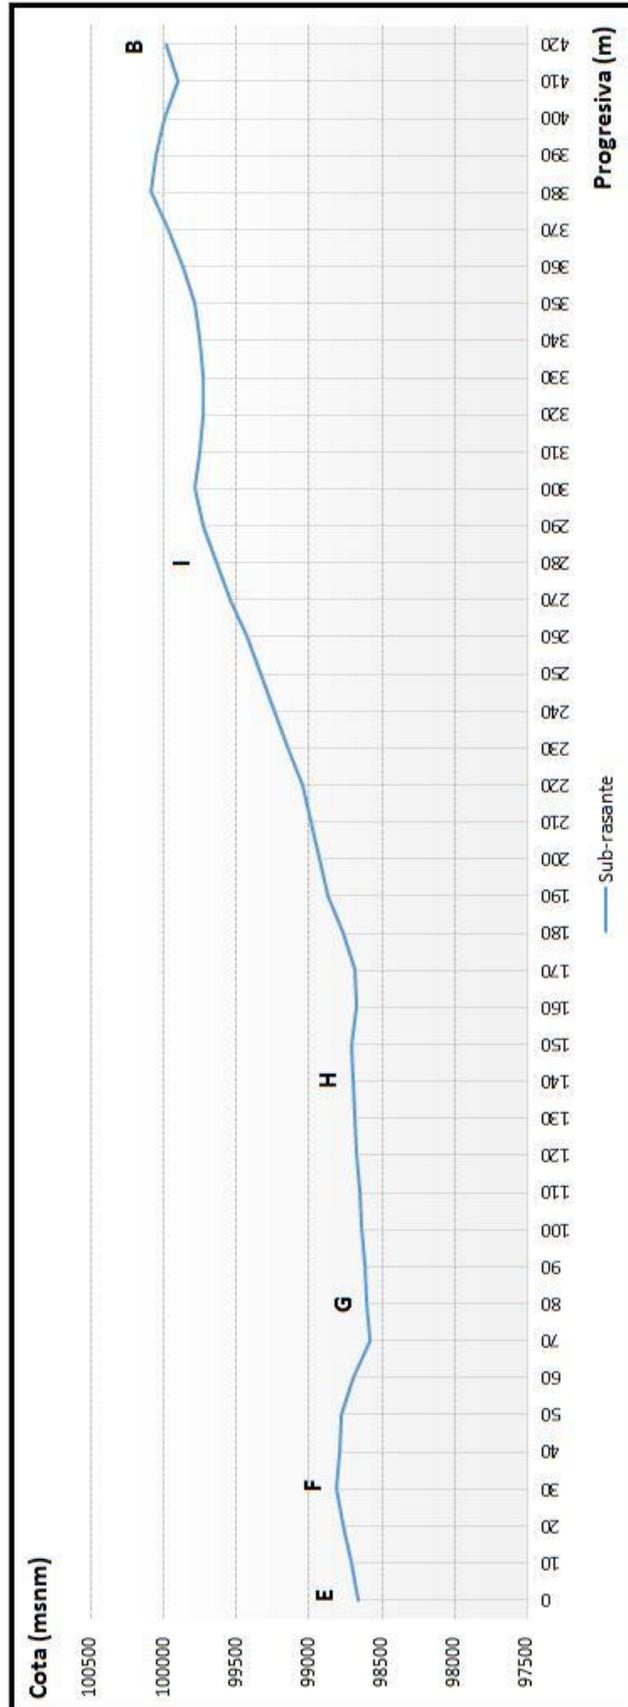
Perfil sub-rasante. Tramo (E – B)
